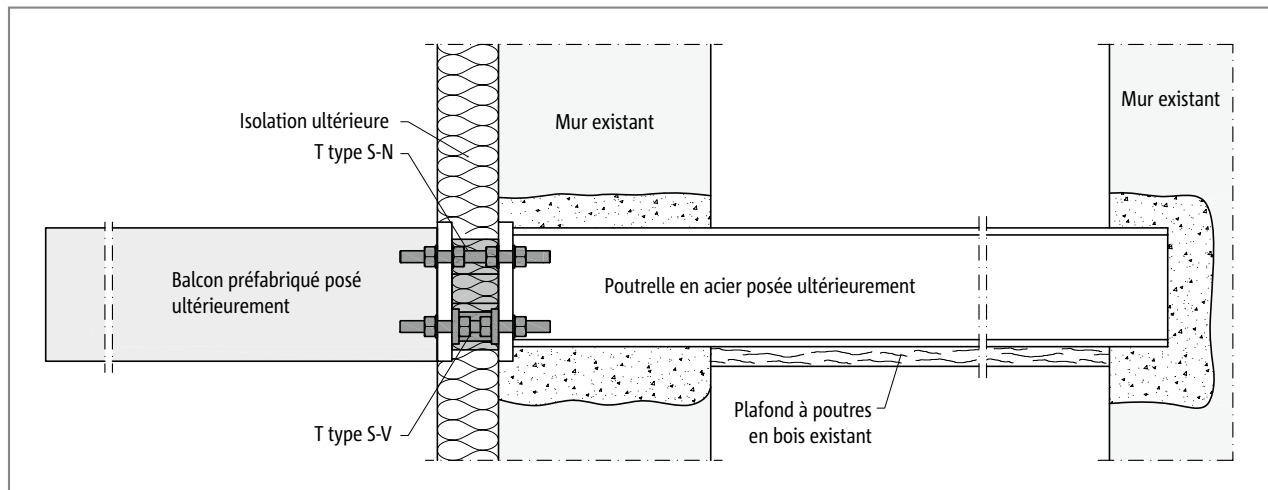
Schöck Isokorb® T type S-N et T type S-V : balcon préfabriqué en porte-à-faux libre posé ultérieurement ; raccordé à des poutres en acier installées ultérieurement ; vissage intérieur
